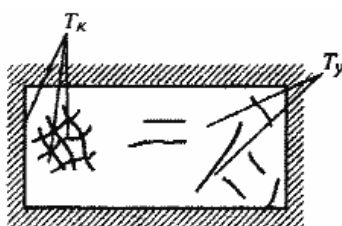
Трещины на потолочной поверхности плиты перекрытия, образовавшиеся от усадки бетона и коррозии арматуры;  $T_k$  — трещины от коррозии;  $T_u$  — трещины усадки бетона.
